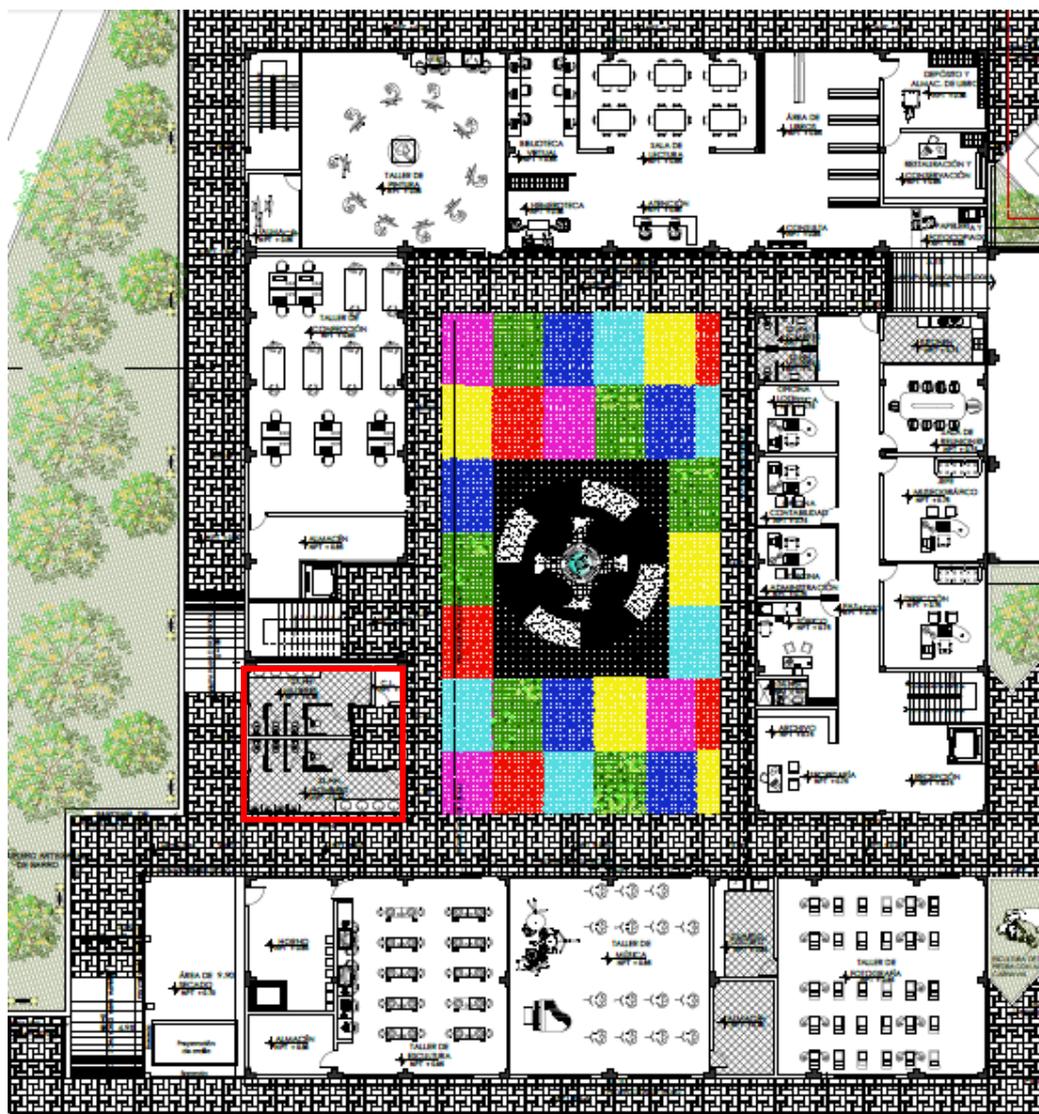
Talleres y Biblioteca – Ubicación de la batería de baños
